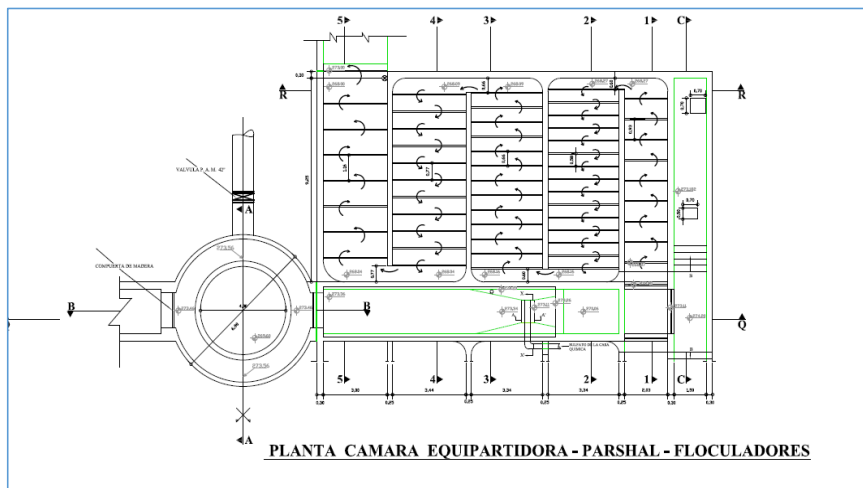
Planta de detalles de la cámara equipartidora, Parshall y alimentación a los módulos de tratamiento
